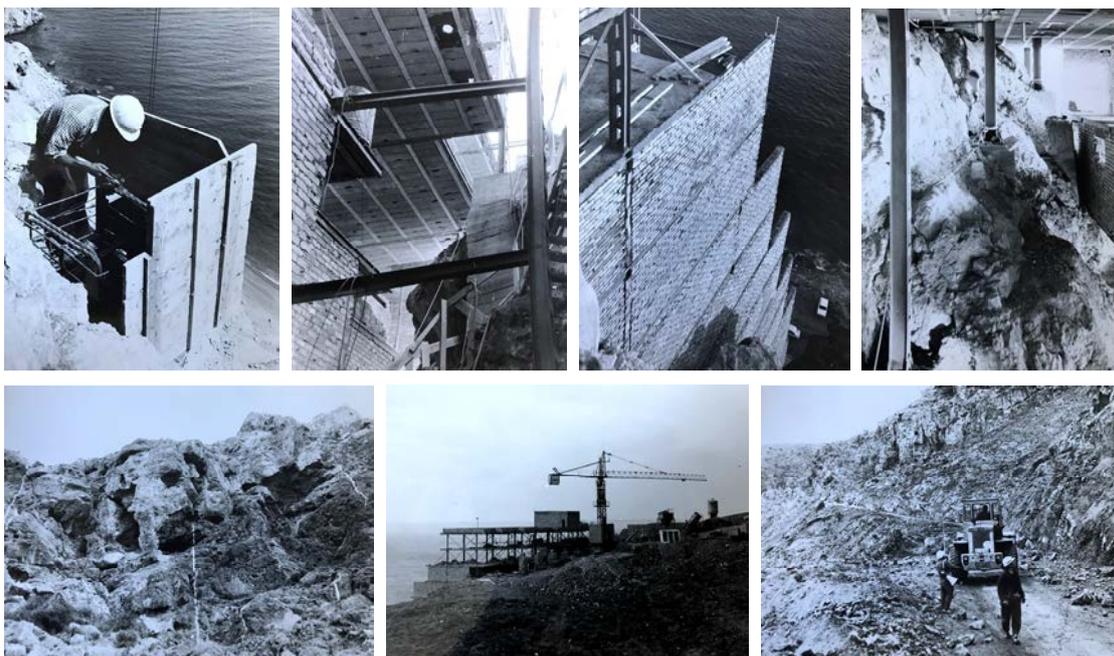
Fotografía durante la construcción de los apartamentos 'Espejo de Mar' —Bloque B—: a) encofrado de una de las zapatas de hormigón armado sobre la roca b) estructura metálica apoyada sobre una zapata de hormigón vertical c) cerramiento de ladrillo exterior en el testero occidental del bloque d) espacios intersticiales entre el Bloque B y la roca madre y el apoyo de los pilares metálicos, cada uno de una altura, sobre zapatas de hormigón e) replanteo con líneas de cal dibujadas sobre la roca f) estructura metálica de las dos últimas plantas superiores g) trabajos de limpieza de la Carretera Nacional después de los desprendimientos provocados durante la obra (1971). [Fuente: Archivo del arquitecto JMGSV].
